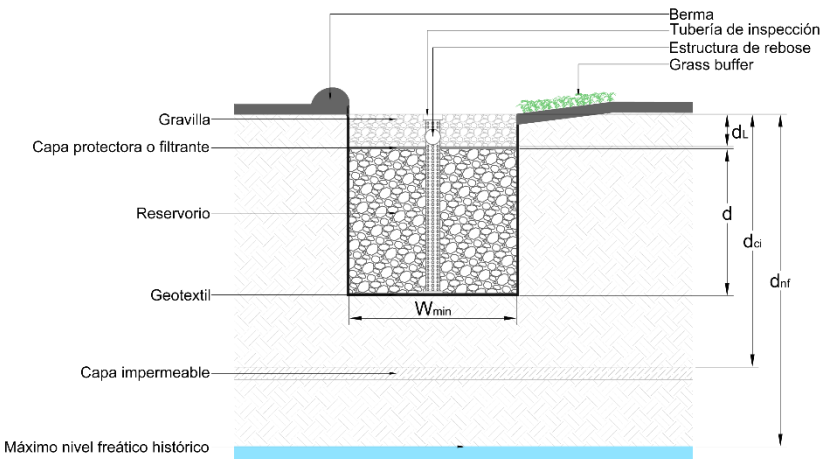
Sección transversal de la estructura – Zanjas de Infiltración. Fuente: Hoja de cálculo de zanjas de infiltración, Anexo NS-166 EAAB-Norma Técnica
